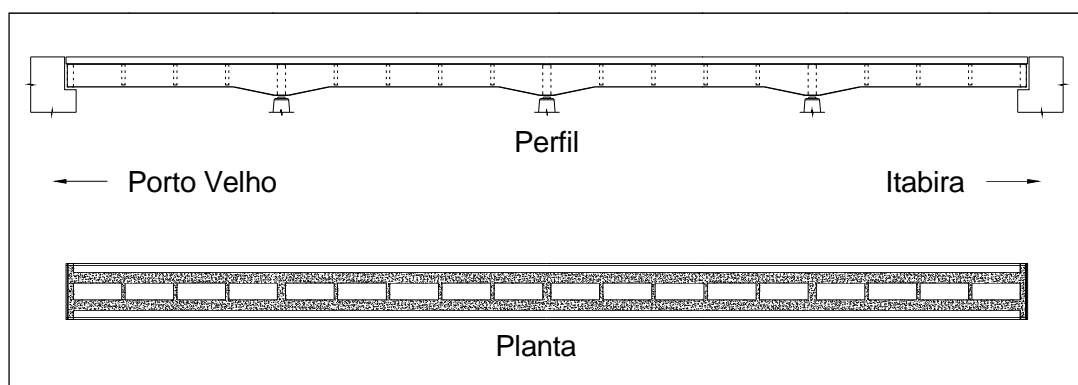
Perfil longitudinal e corte em planta da estrutura (sem escala).
